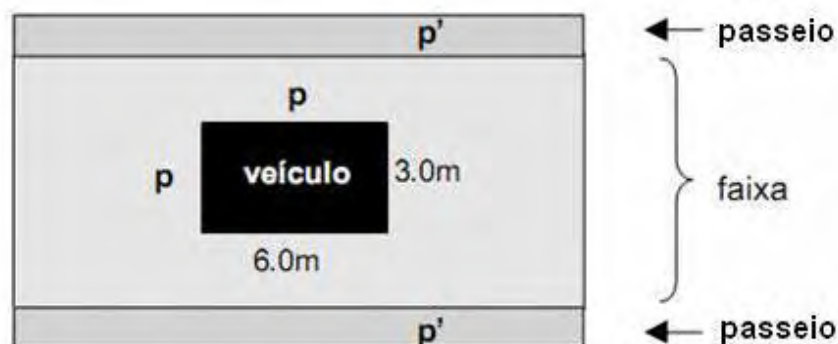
Disposição em planta das cargas móveis. Fonte: NBR 7188 (1982)
